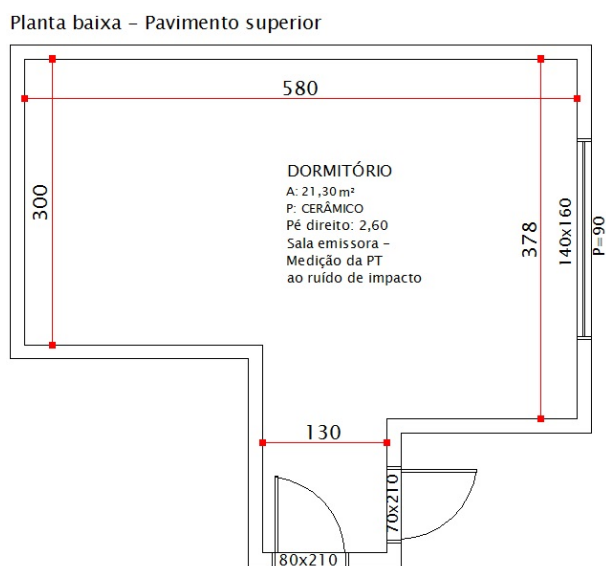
Planta baixa - pavimento superior - 08-R8-N-PC
